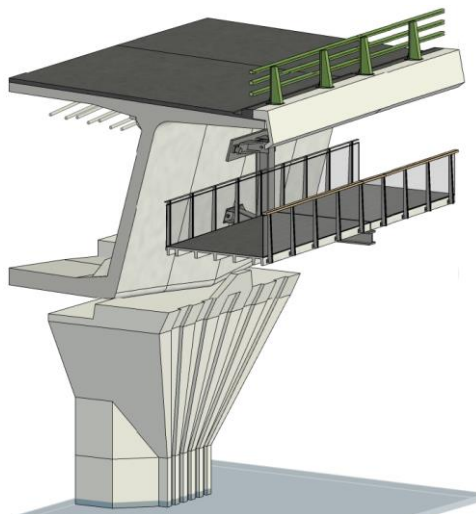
Extrait cahier de plan – Vue d’une console courante avec platelage
